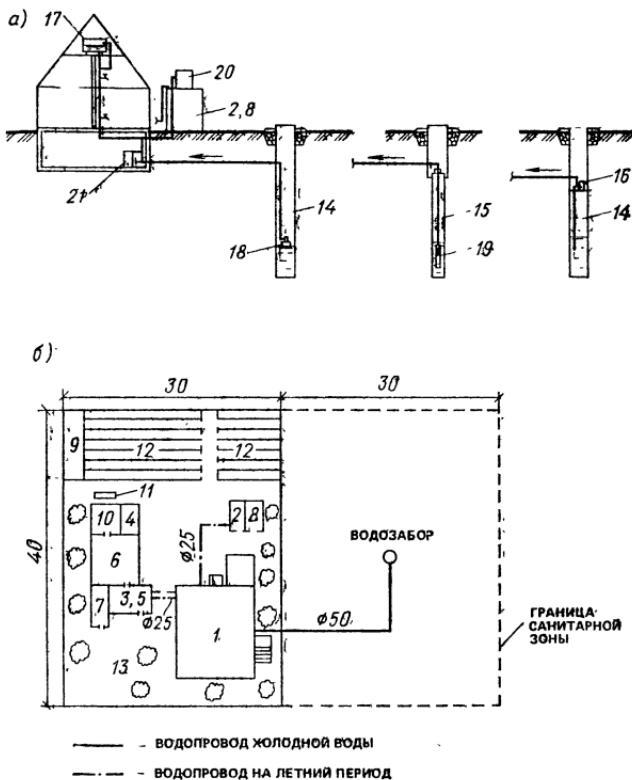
Схема водоснабжения жилого дома (а) и генплан участка с жилым домом (б)
